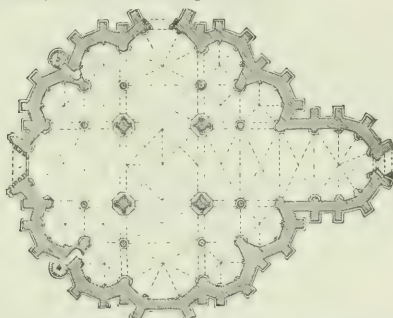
Liebfrauenkirche zu Trier. Grundriß. S. 65.
